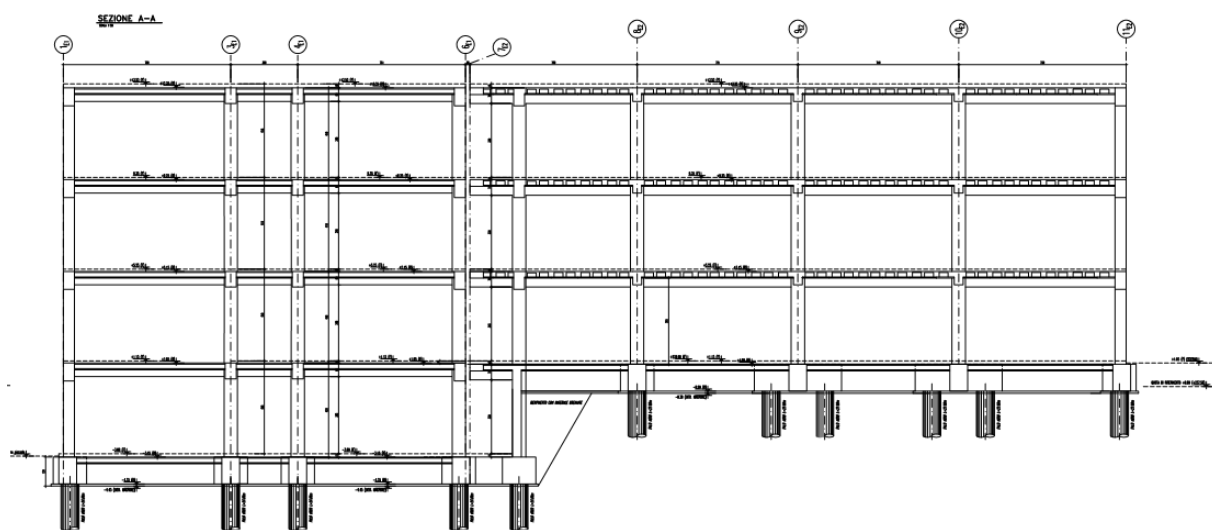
Sezione longitudinale corpi E1 ed E2
